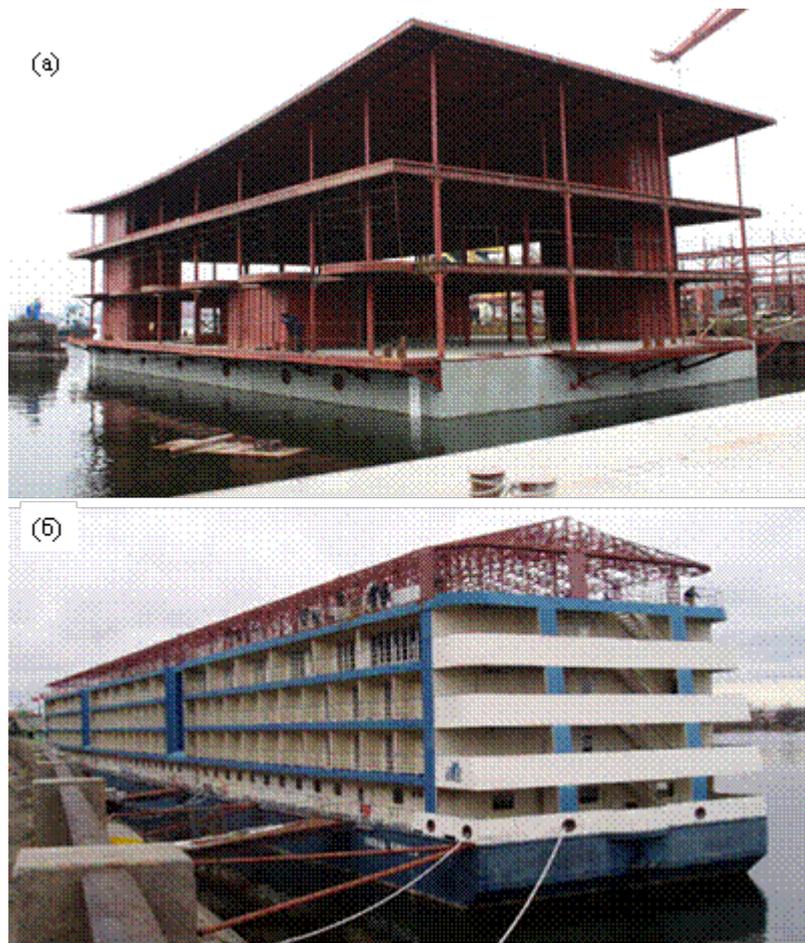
Плавающие железобетонные сооружений, произведенные на ХГЗ «Паллада»: а - готовый понтон плавучего отеля с надстройкой, б - эксплуатируемая плавучая гостиница "Баккара" в г. Киев с железобетонным понтоном.
